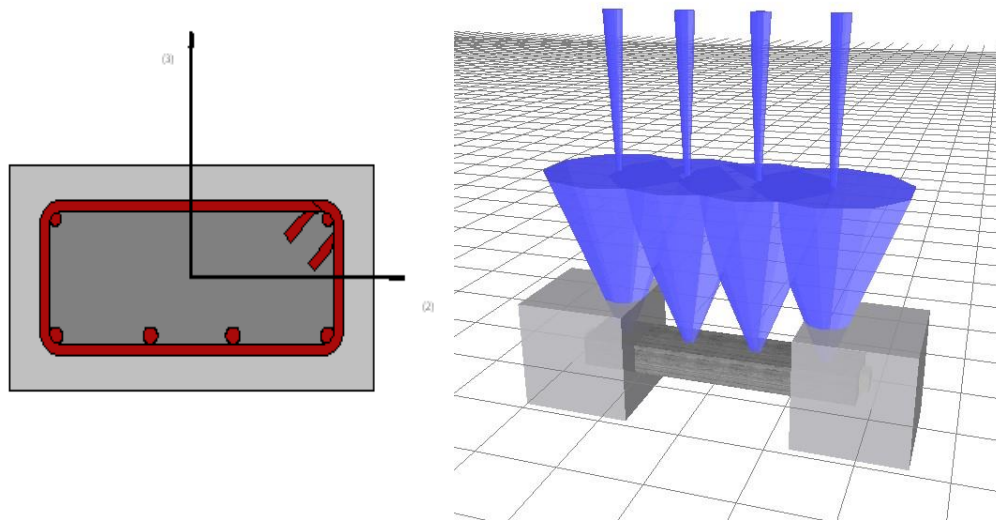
Modelação em SeismoStruct. a) Secção transversal, viga B100(12). b) Carga aplicada, viga B100(12) e B140.
